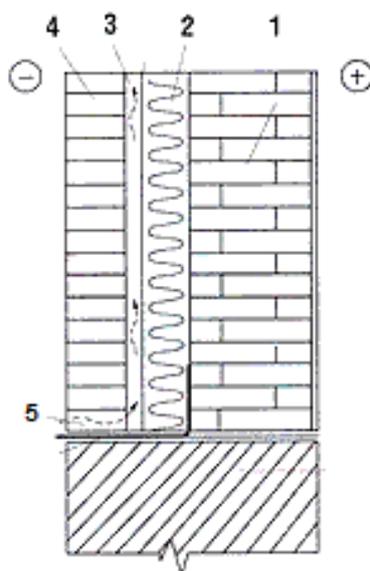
Наружная стена с вентилируемой воздушной прослойкой и облицовкой кирпичом: 1 - утепляемая стена; 2 - утеплитель; 3 - вентилируемая воздушная прослойка; 4 - наружная облицовка; 5 - вентиляционный продух.
